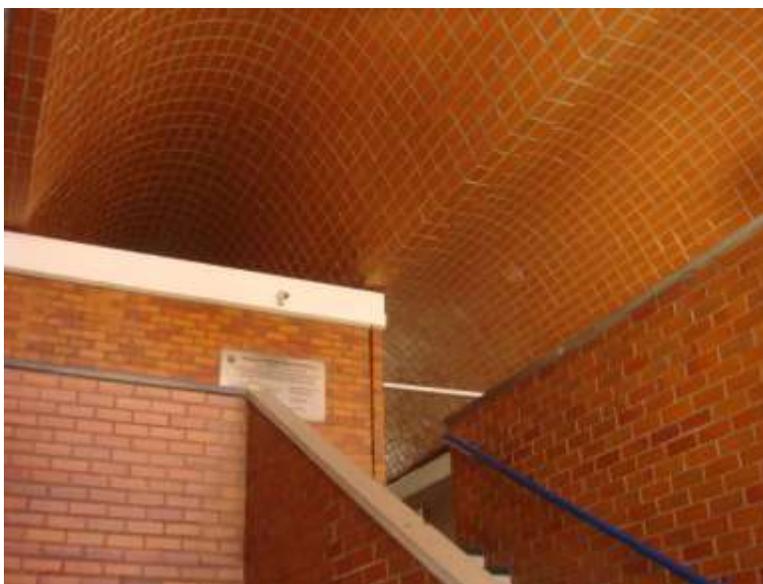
Vista da escada de acesso ao primeiro pavimento, das paredes e da cobertura em material cerâmico. Foto: CANTALICE II.
